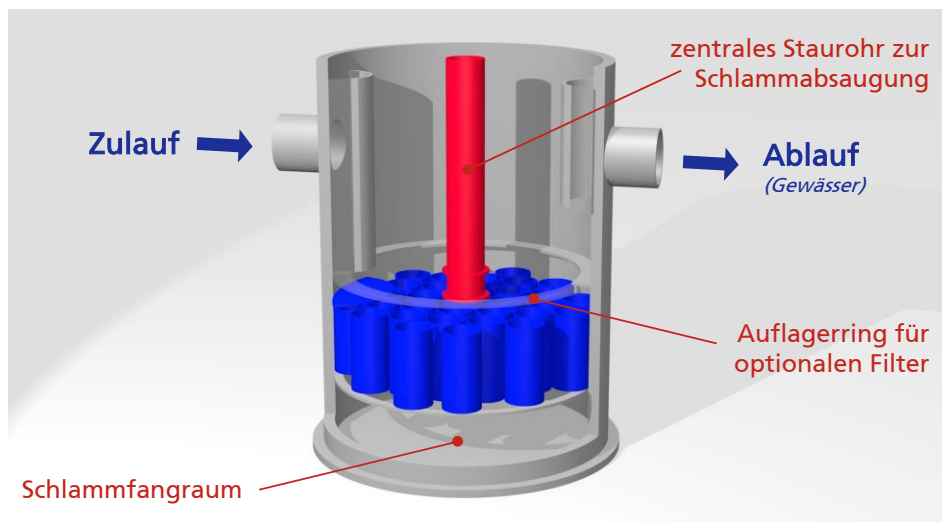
Vorbereitung der 1. Ausbaustufe des Systems FiltaPex® · modular zur Nachrüstung mit einem Filter durch Einstecken eines zentralen Staurohrs in das vorhandene Lamellenpaket
